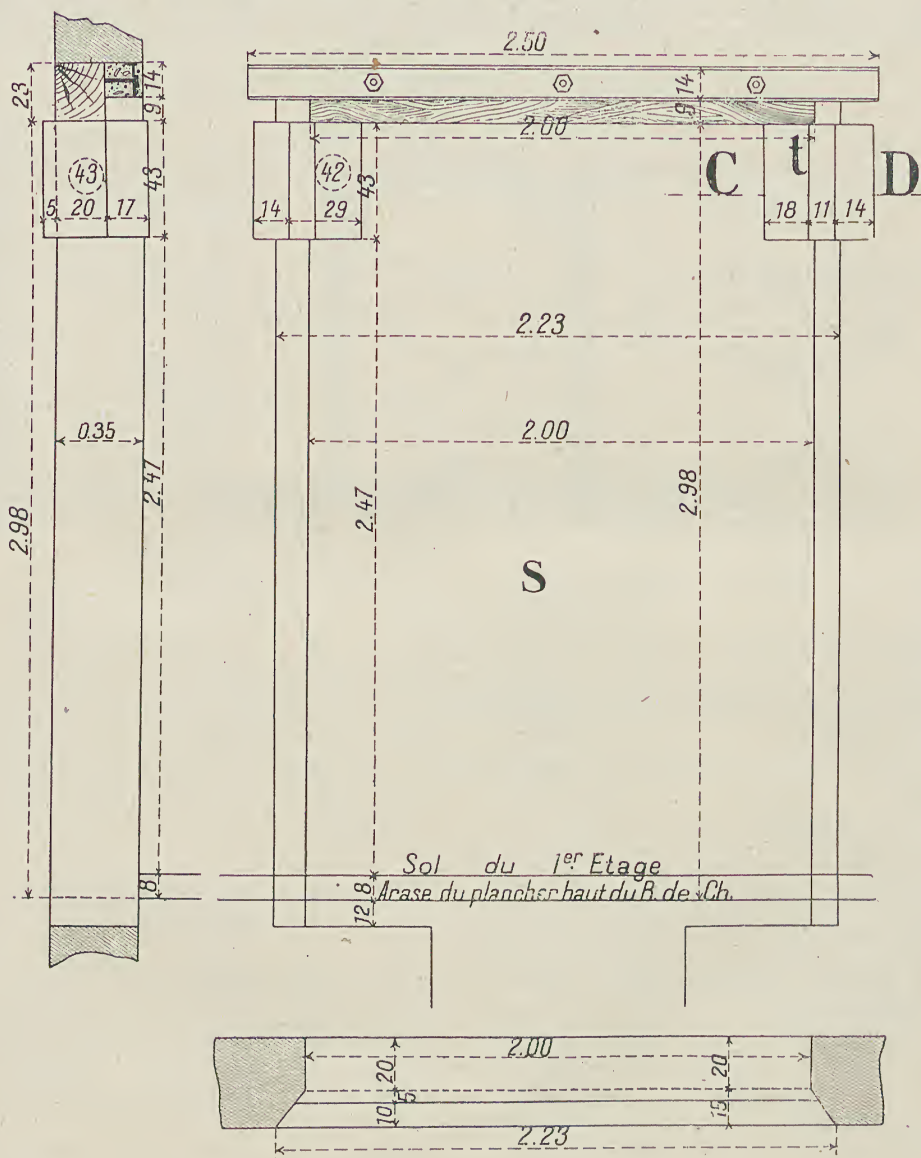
à 681. — Baie S ; coupe, élévation intérieure et plan.
